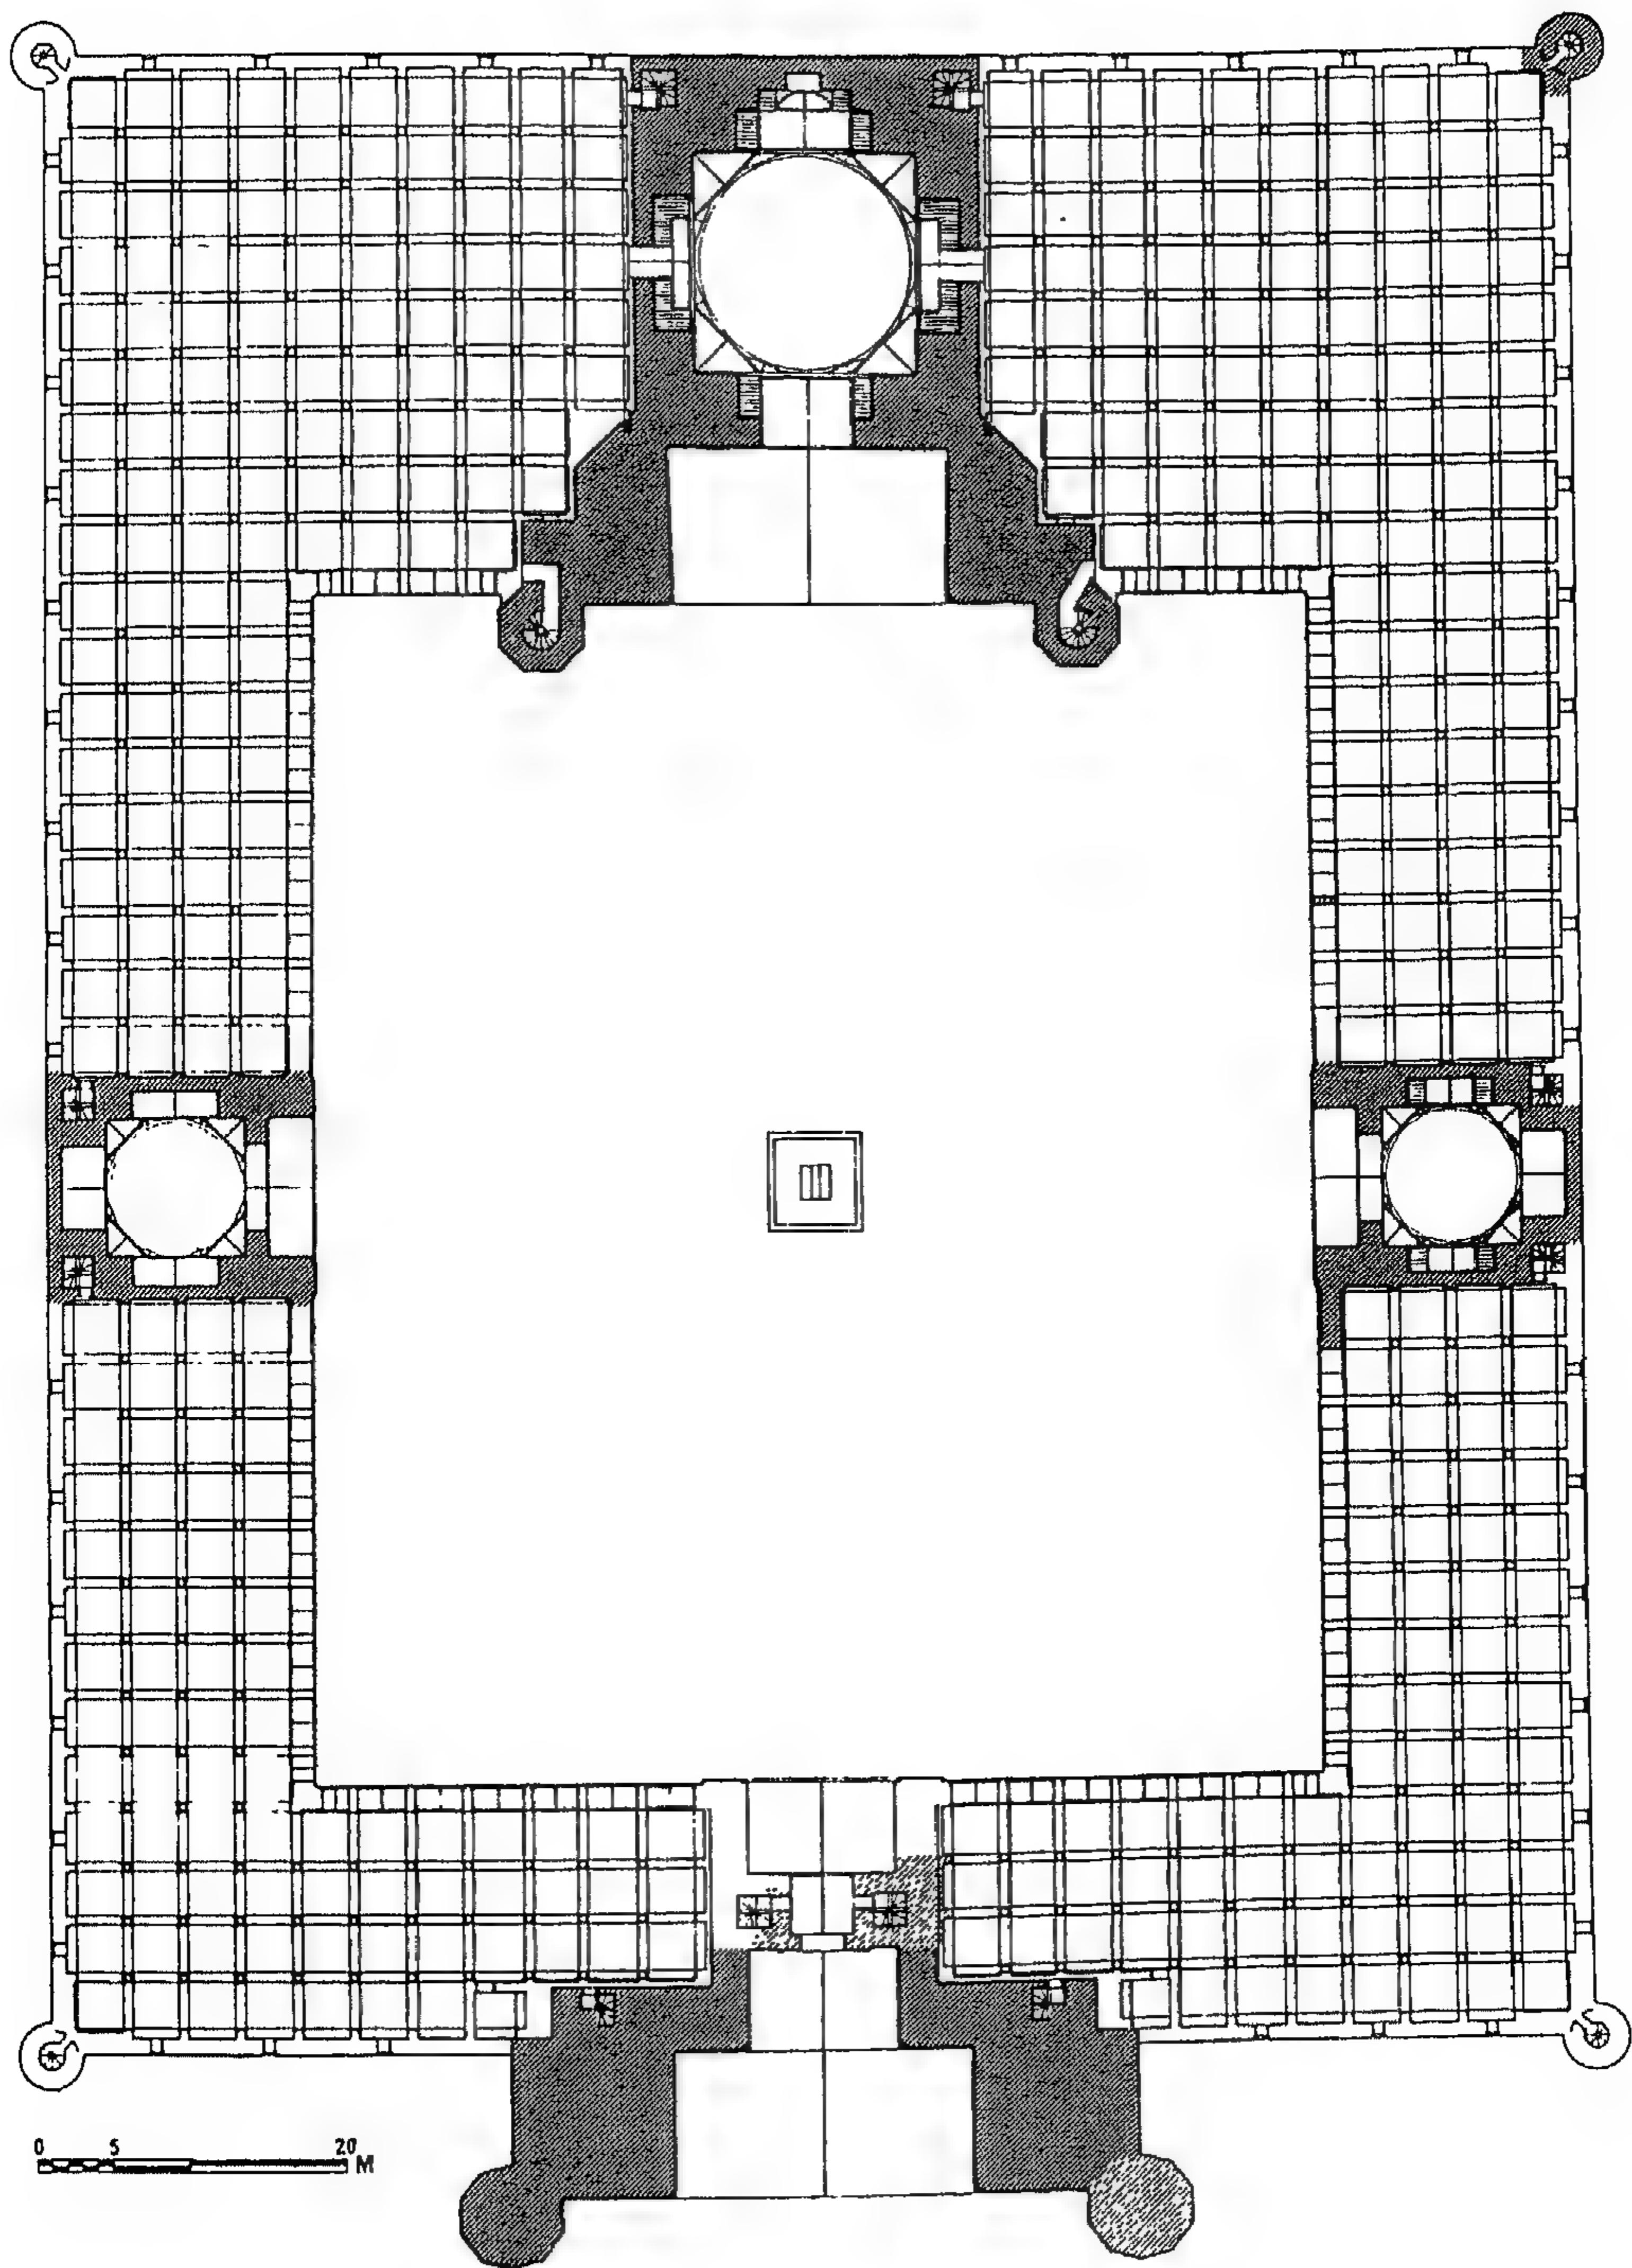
مسقط أفقي لجامع زواره . (عن : أصلان آبا) .
